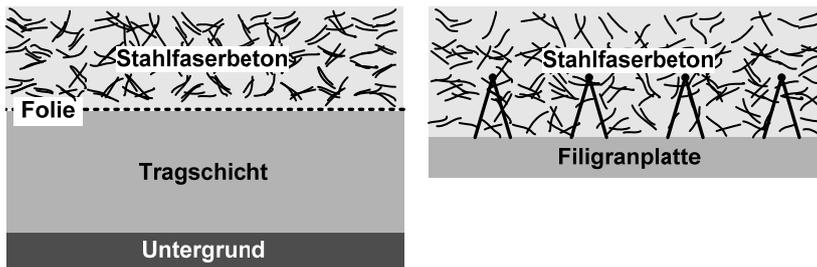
Stahlfaserbeton als Aufbeton auf einer Filigrandeckenplatte oder als Bodenplatte
